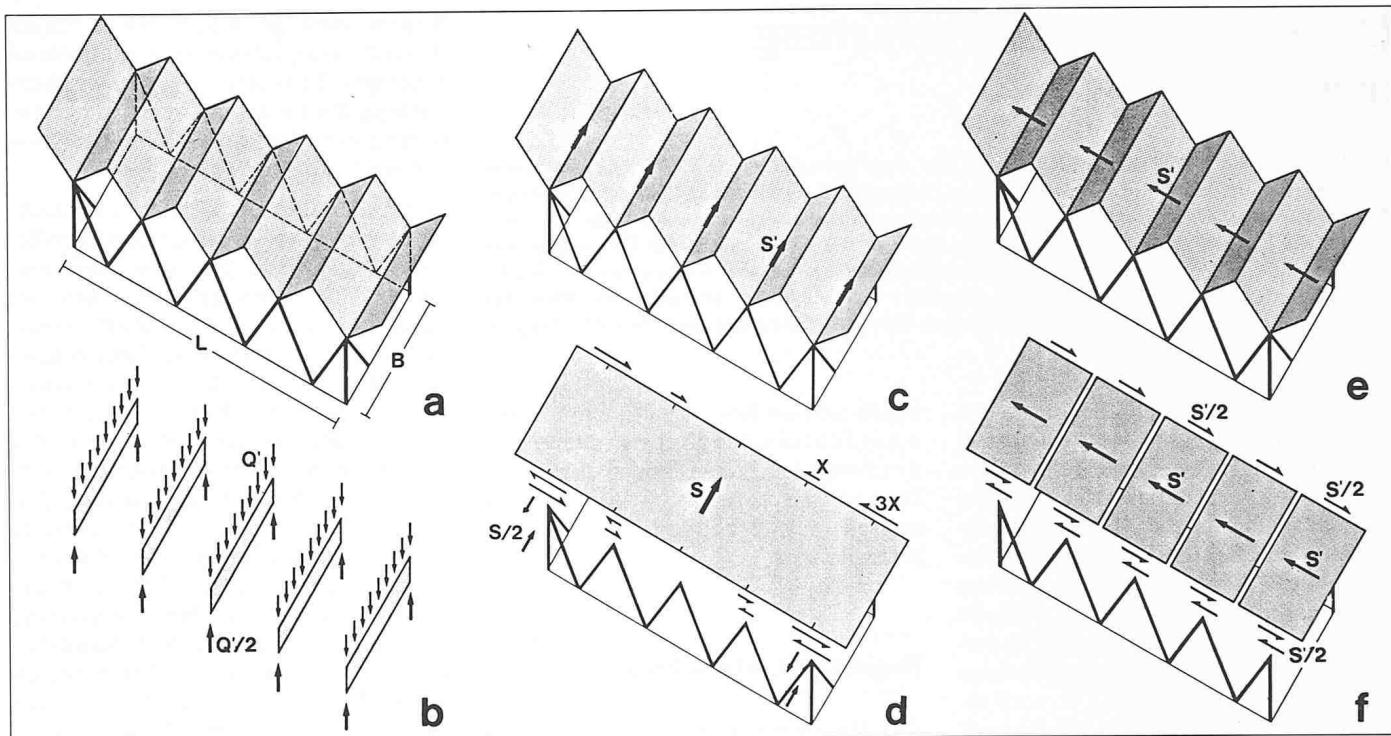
a) Hallentragwerk aus einem V-Faltendach und schrägen Stützen, b) Membranwirkung des Daches in der Hallenquerrichtung bei Vertikallast, c) Tragwerk und Horizontallast in der Hallenquerrichtung, d) entsprechendes Tragverhalten, e) Tragwerk und Horizontallast in der Hallenlängsrichtung, f) entsprechendes Tragverhalten
